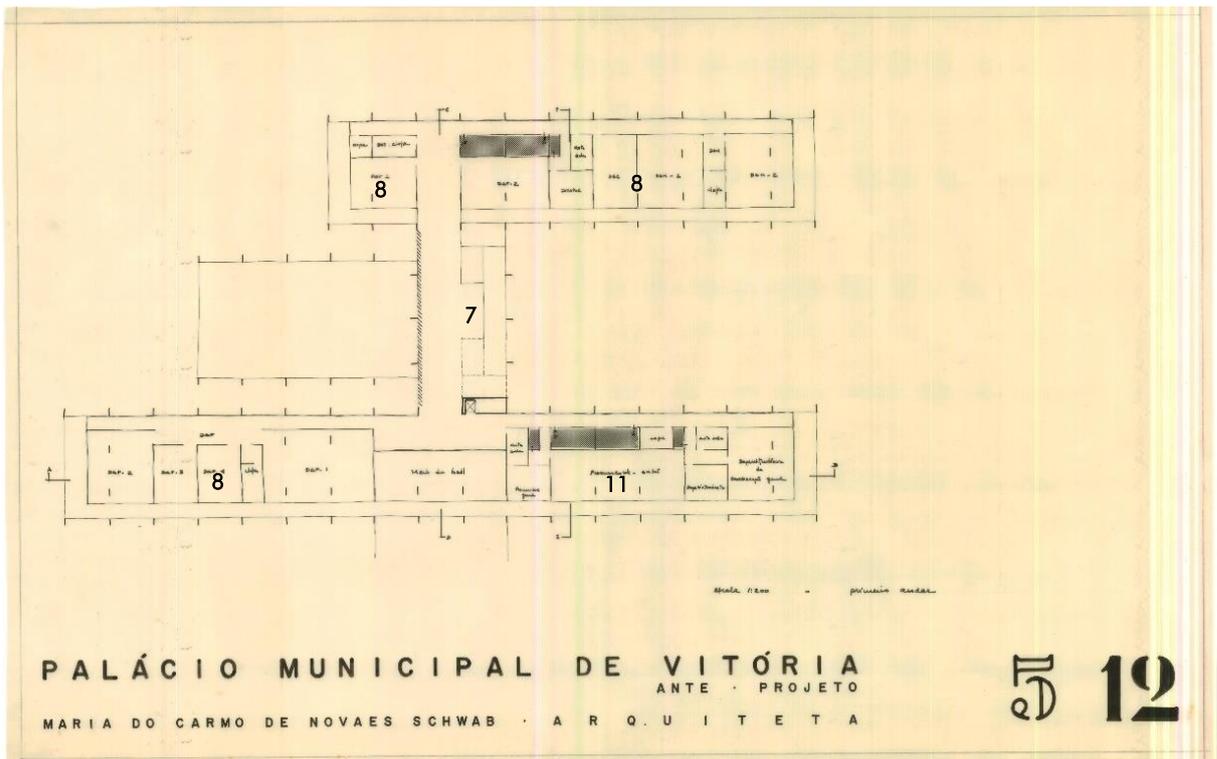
Prancha 5/12, constando planta-baixa esquemática referente ao primeiro pavimento, destacando-se a continuidade do pé-direito do hall de acesso e a cobertura do bloco intermediário de somente 2 pavimentos. Programa - setores: 1. Hall de entrada; 2. Plenário; 3. Câmara; 4. Arquivo; 5. Biblioteca; 6. Assistência médica; 7. Rampa; 8. Salas departamentais; 9. Gabinete do prefeito; 10. Auditório; 11. Sala procuradoria e superintendência.
